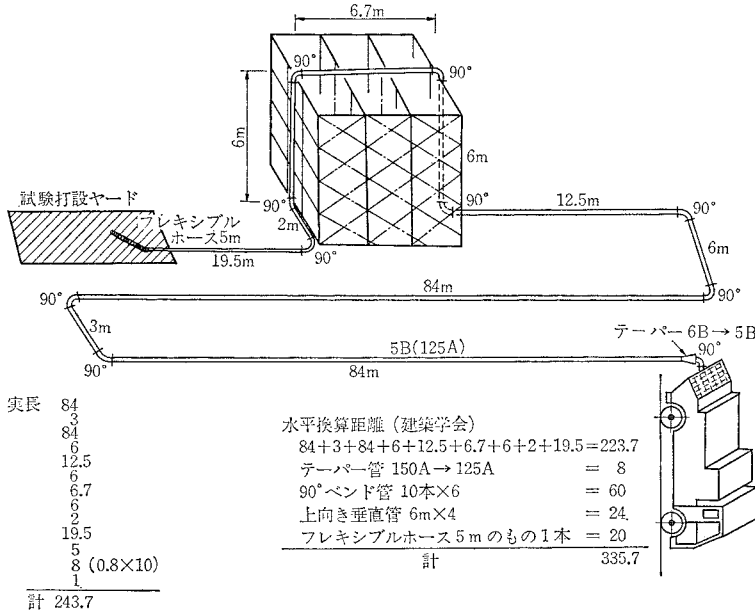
圧送試験配管状況 (配管径 5B (125A) 管)
